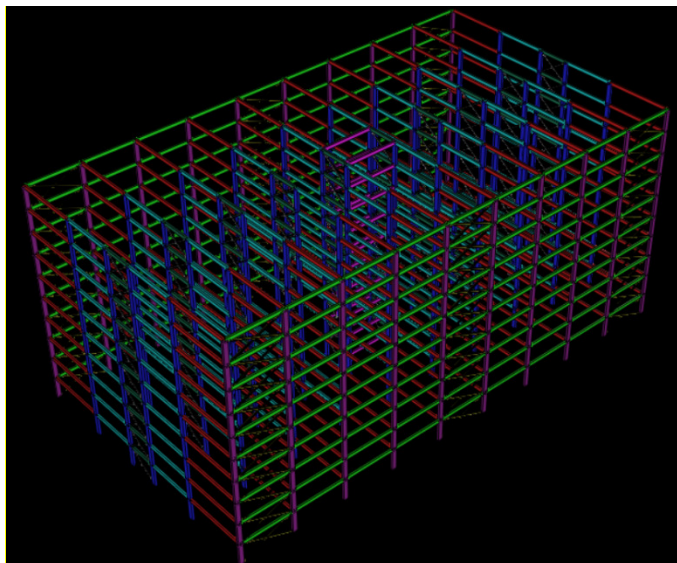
Pórtico espacial do edifício garagem contraventado por pórticos treliçados.
